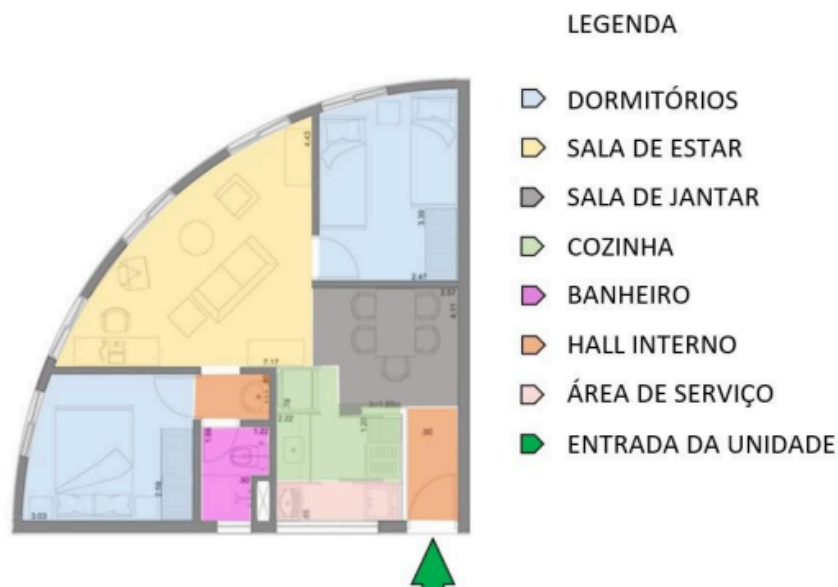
Planta baixa pavimento térreo do residencial Heliópolis I.
